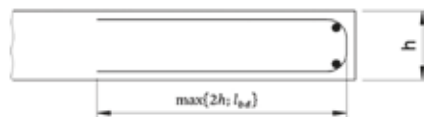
ARMADURA DE EXTREMIDADE PARA AS LAJES
